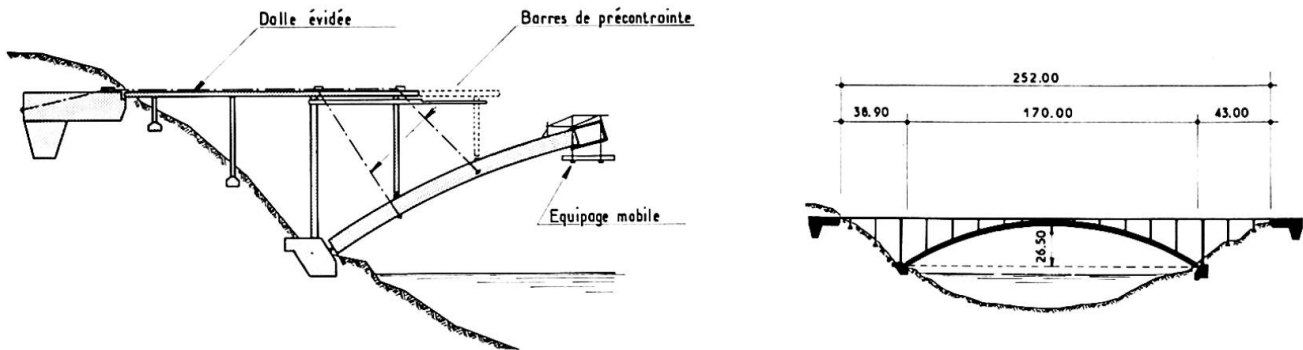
Construction du pont de HOKAWAZU (Japon)
